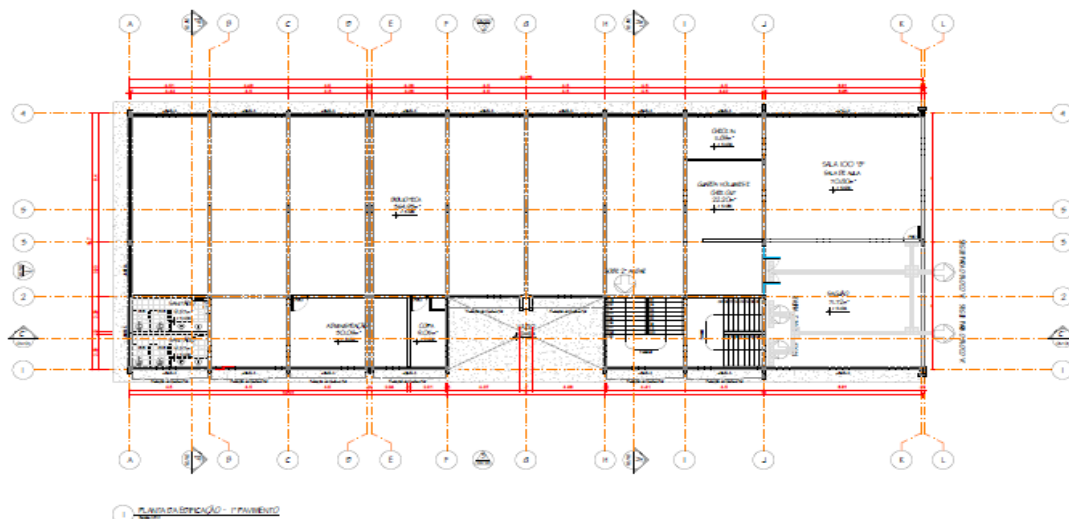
Edificação selecionada para estudo “Bloco B” (Imagem retirada da planta baixa da edificação).
